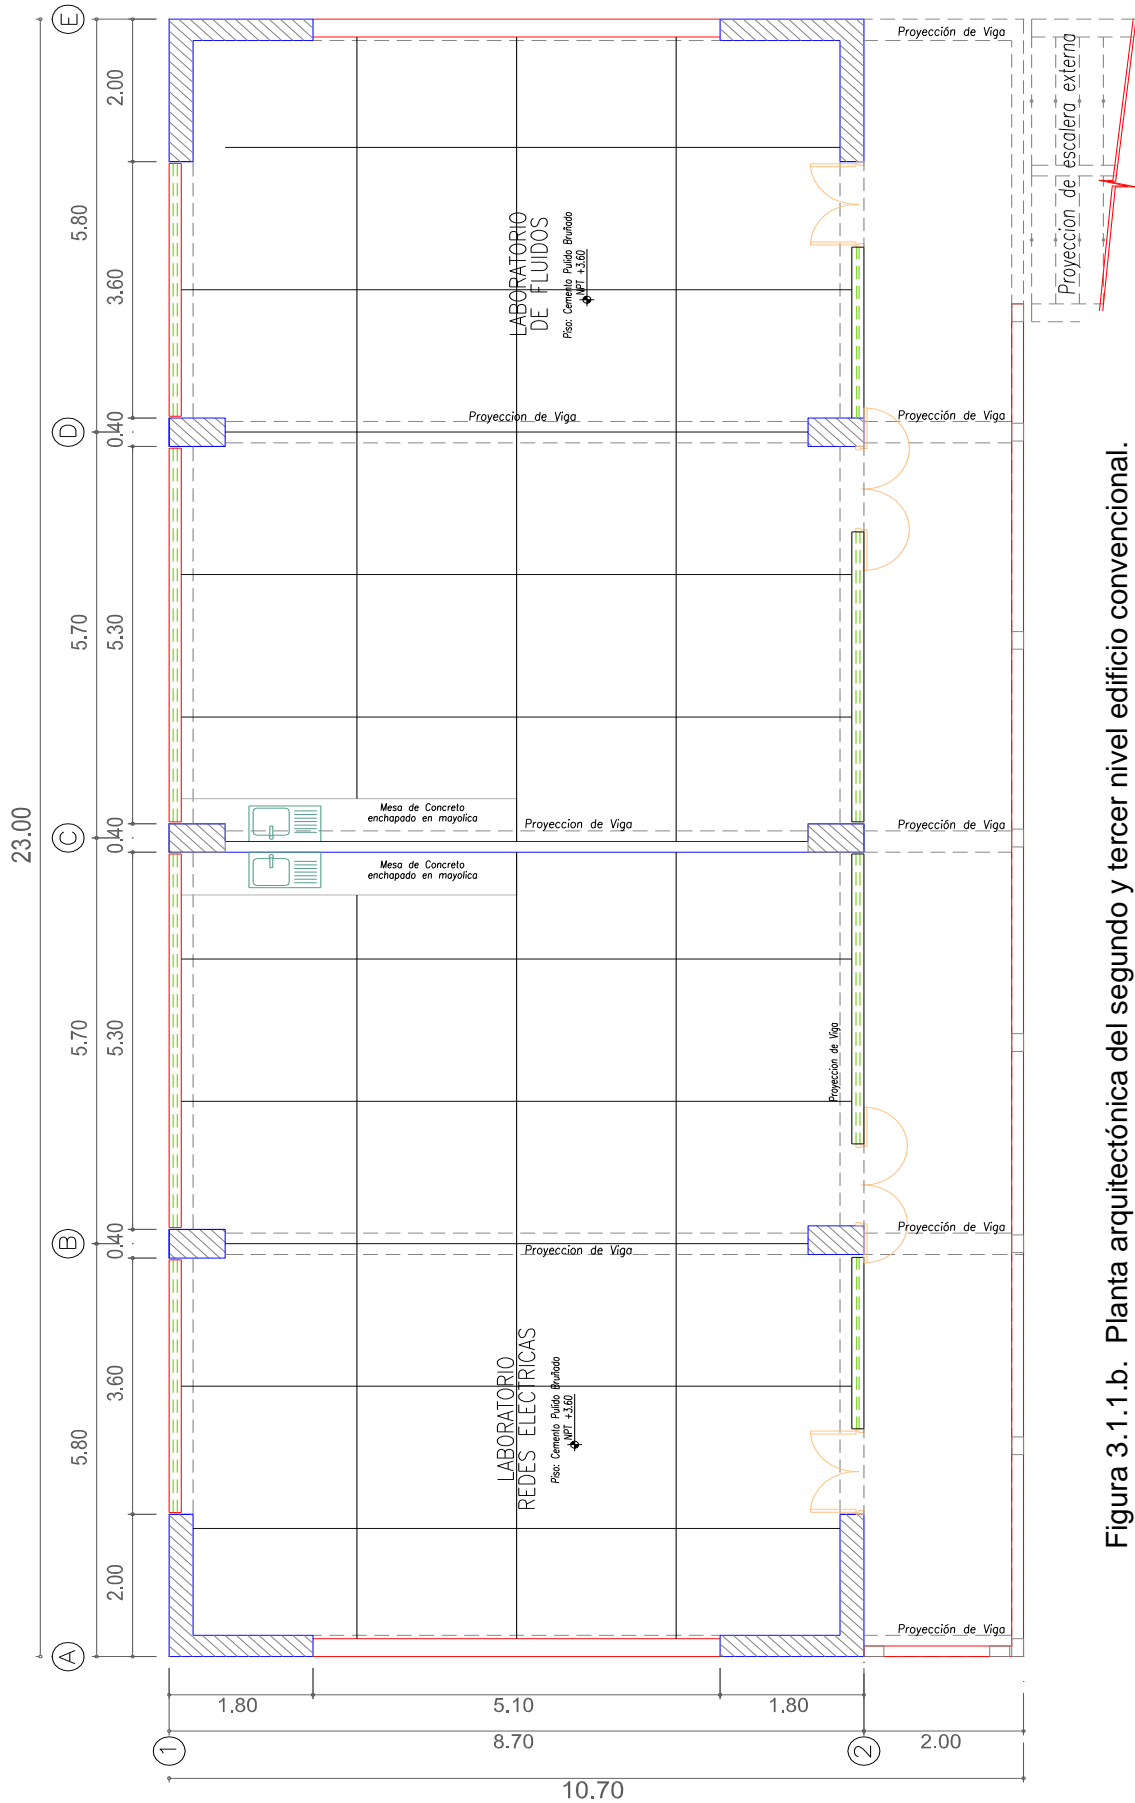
b. Planta arquitectónica del segundo y tercer nivel edificio convencional.
